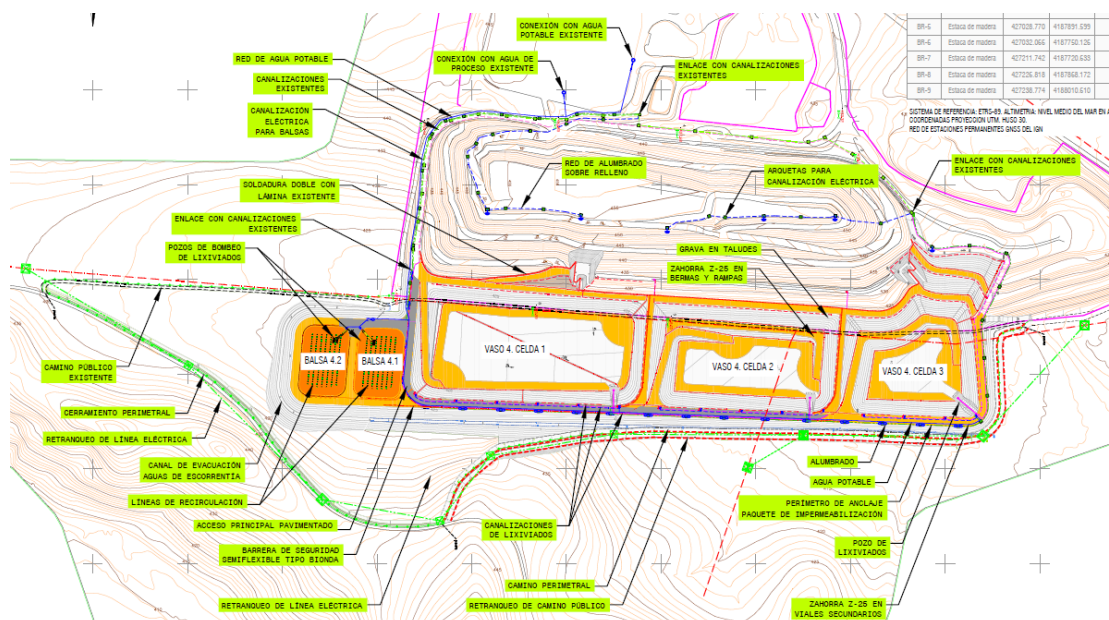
Planta general de las actuaciones propuestas. Fuente: extracto del plano 04.1.1. del proyecto de construcción aportado
